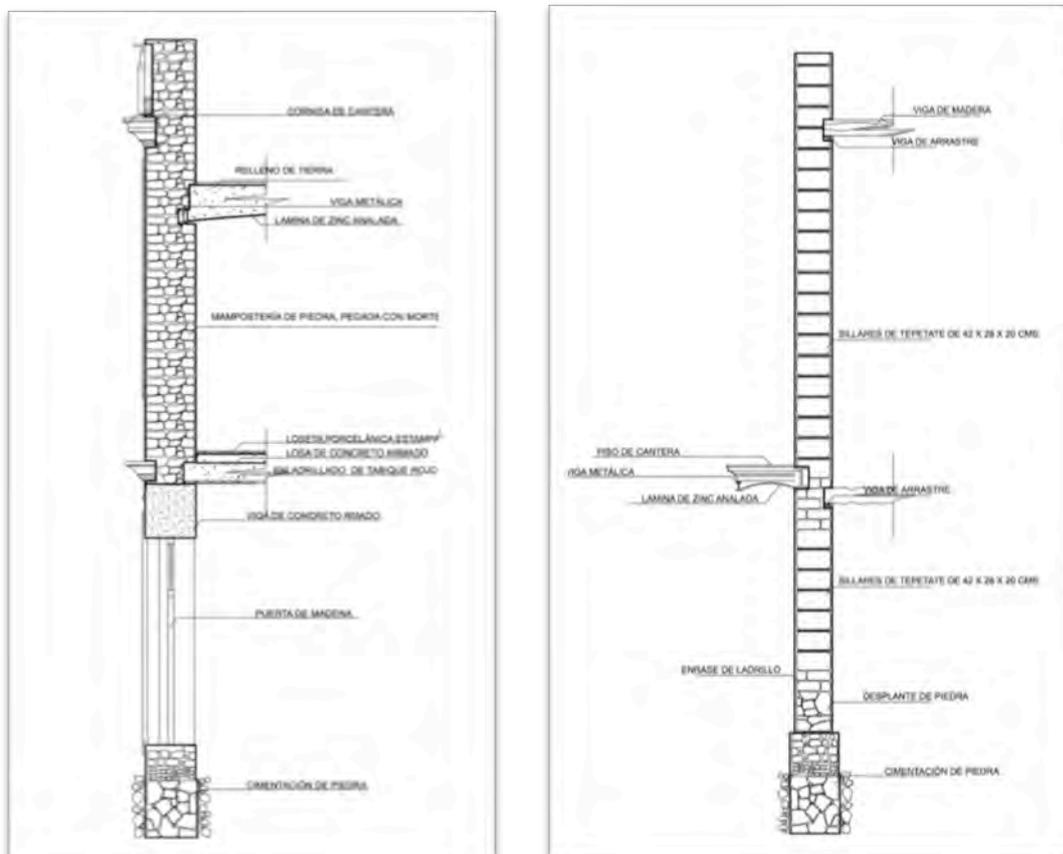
y 27. Corte por fachada de un muro de mampostería de piedra y otro de sillares de tepetate.
